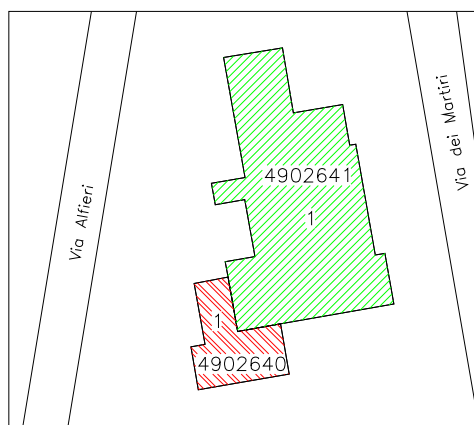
Pianta dell'aggregato con suddivisione in unità strutturali (US) e indicazione delle vie circostanti.
